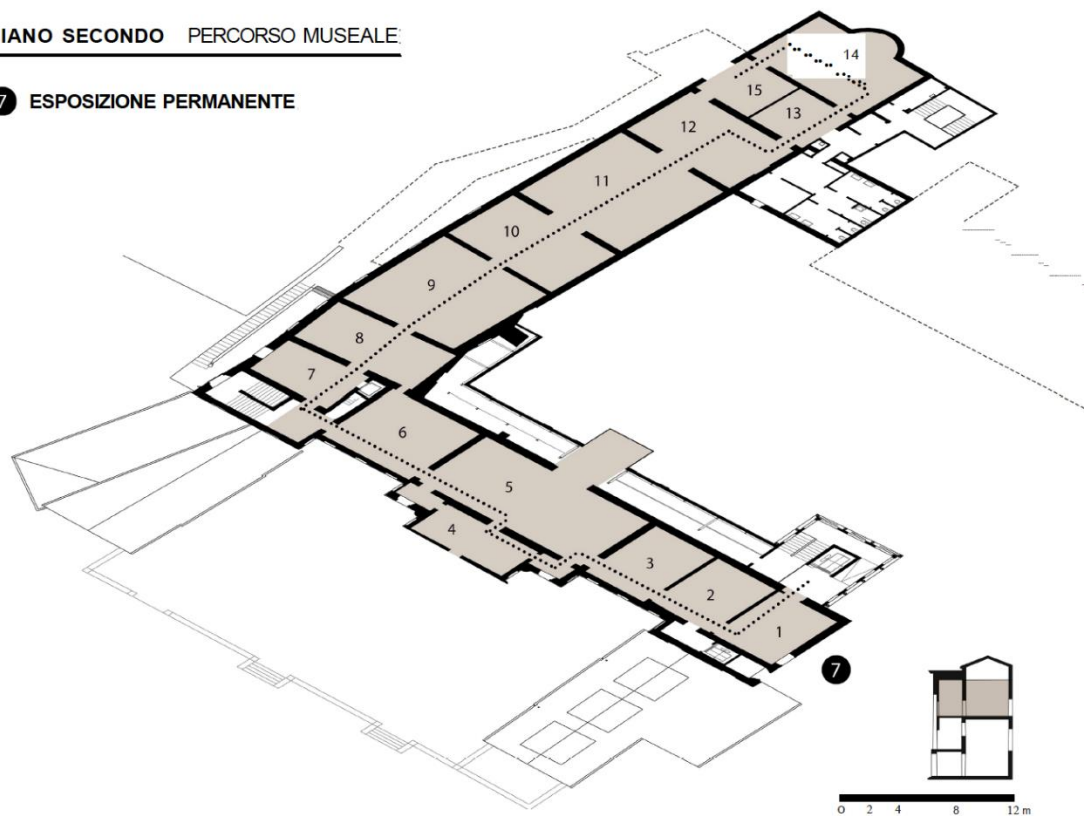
Pianta del percorso museale della collezione permanente. Archivio dell'Accademia Carrara.
